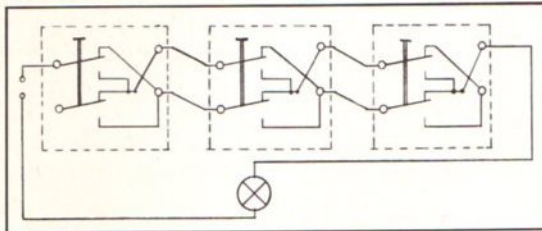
Schaltskizze zur Abb. 6, die gestrichelte Linie deutet das Gehäuse der Schalter an; in der Zeichnung sind nur drei der vier Schalter gezeichnet.
